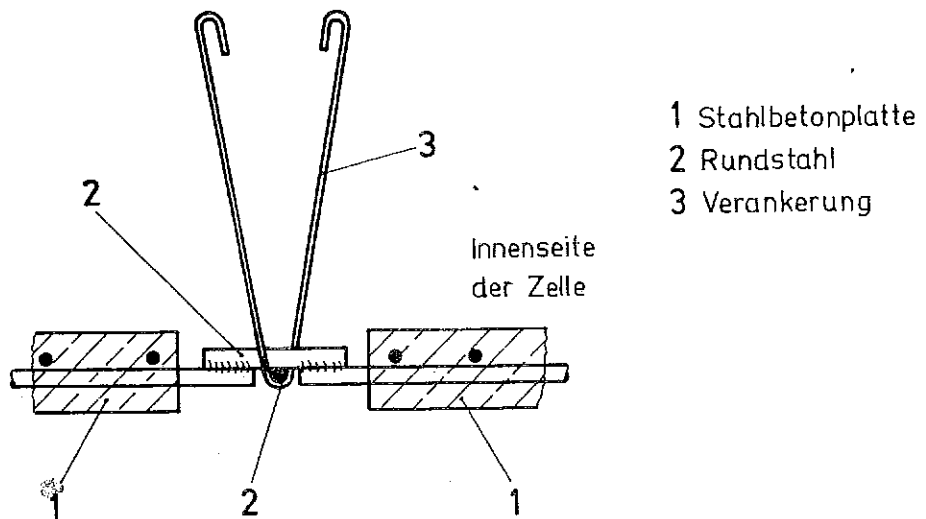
Bewehrungsstoß der Stahlbetonplatten
